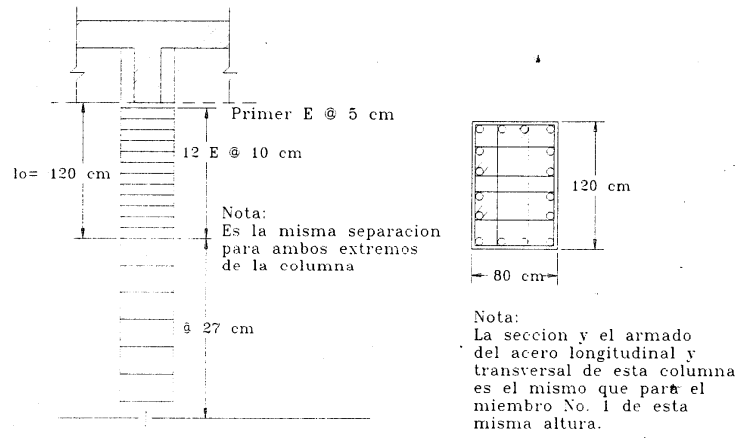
Colocacion de acero longitudinal y transversal
